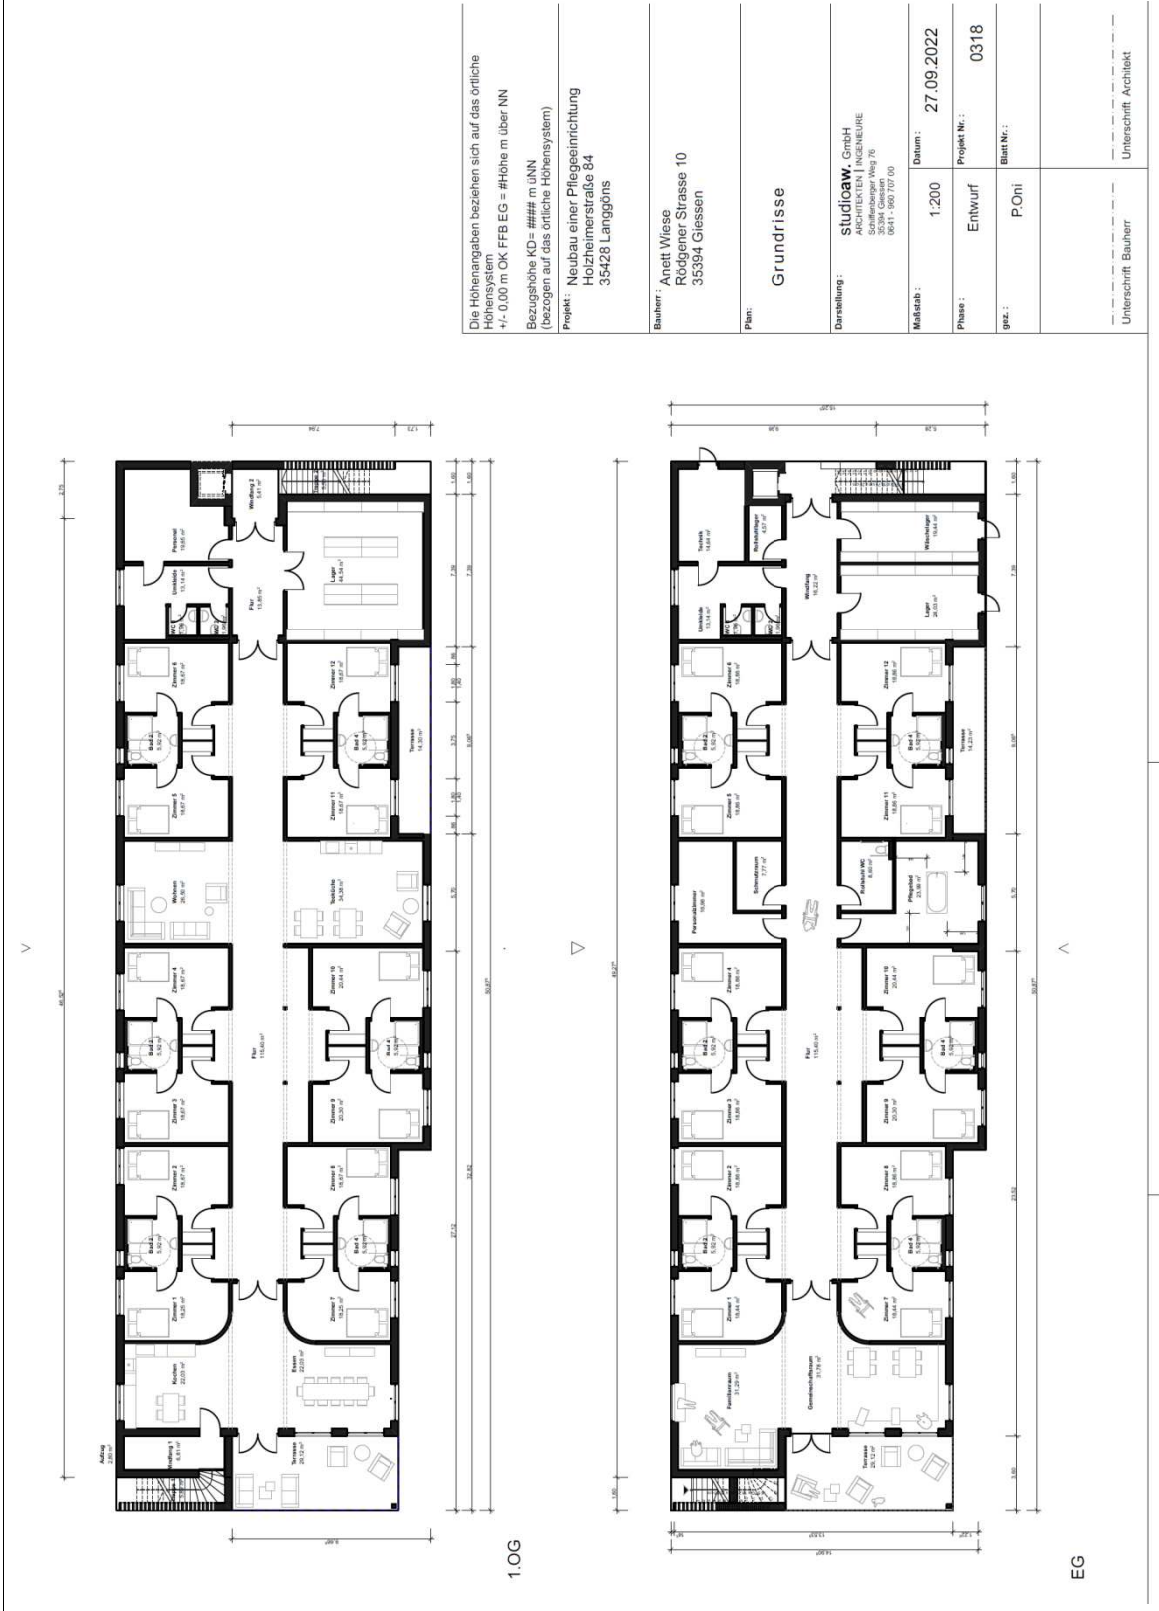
Grundriss EG und OG, studioaw. GmbH vom 27.09.2022
